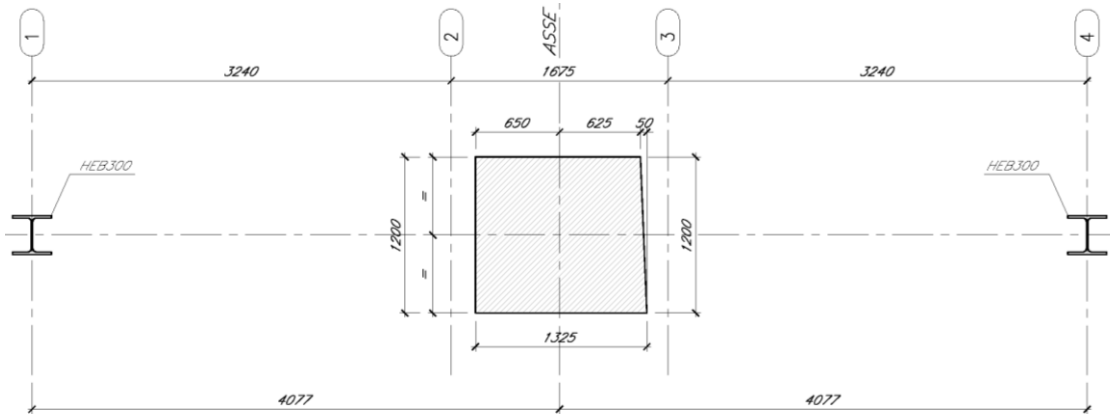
Sezione orizzontale pila 1 - Geometria [mm]
